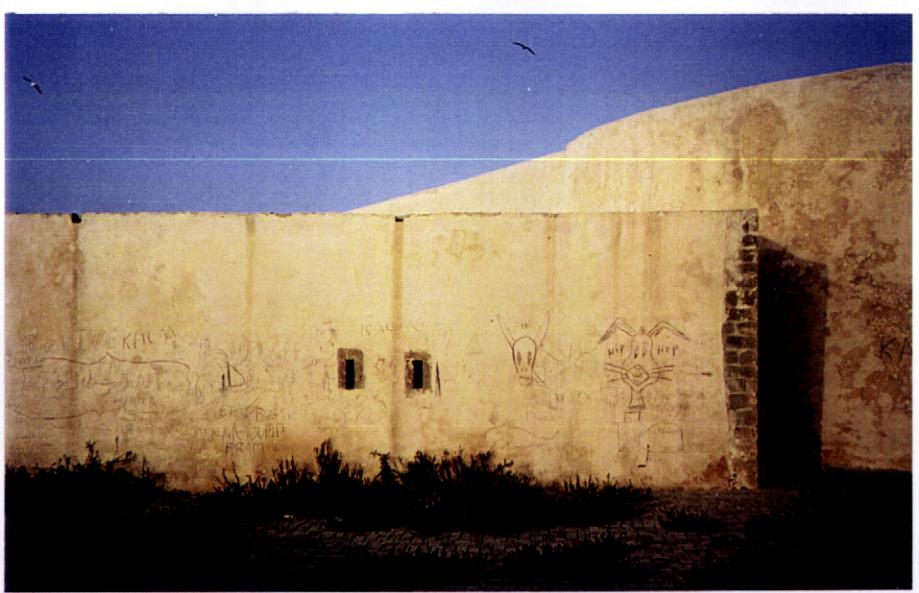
Reboco do tipo A / Fachada Sul – Setembro de 2000.
